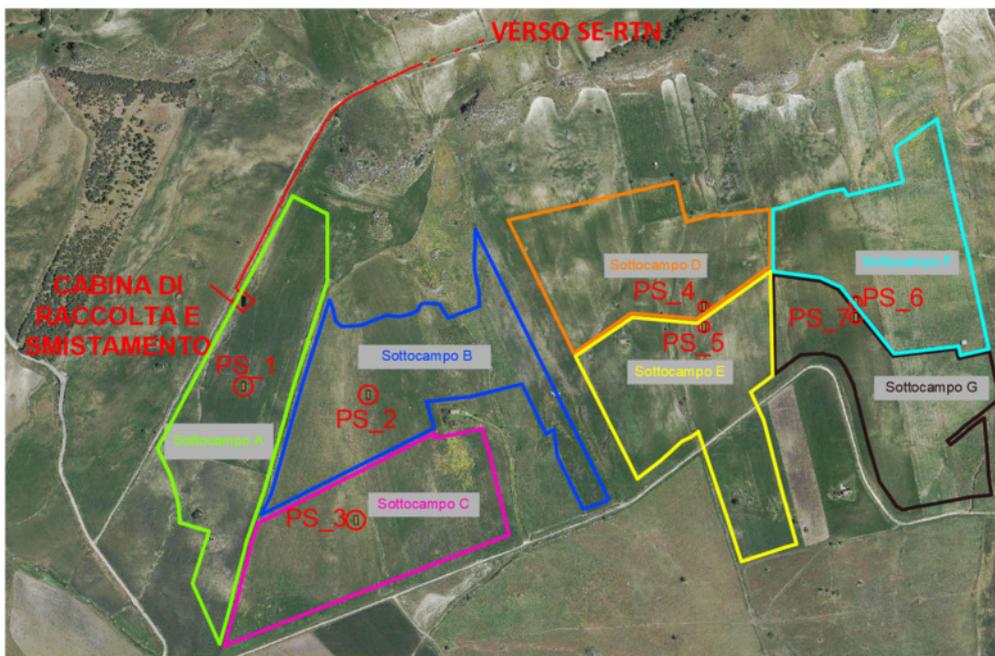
Suddivisione in sottocampi del layout d'impianto
